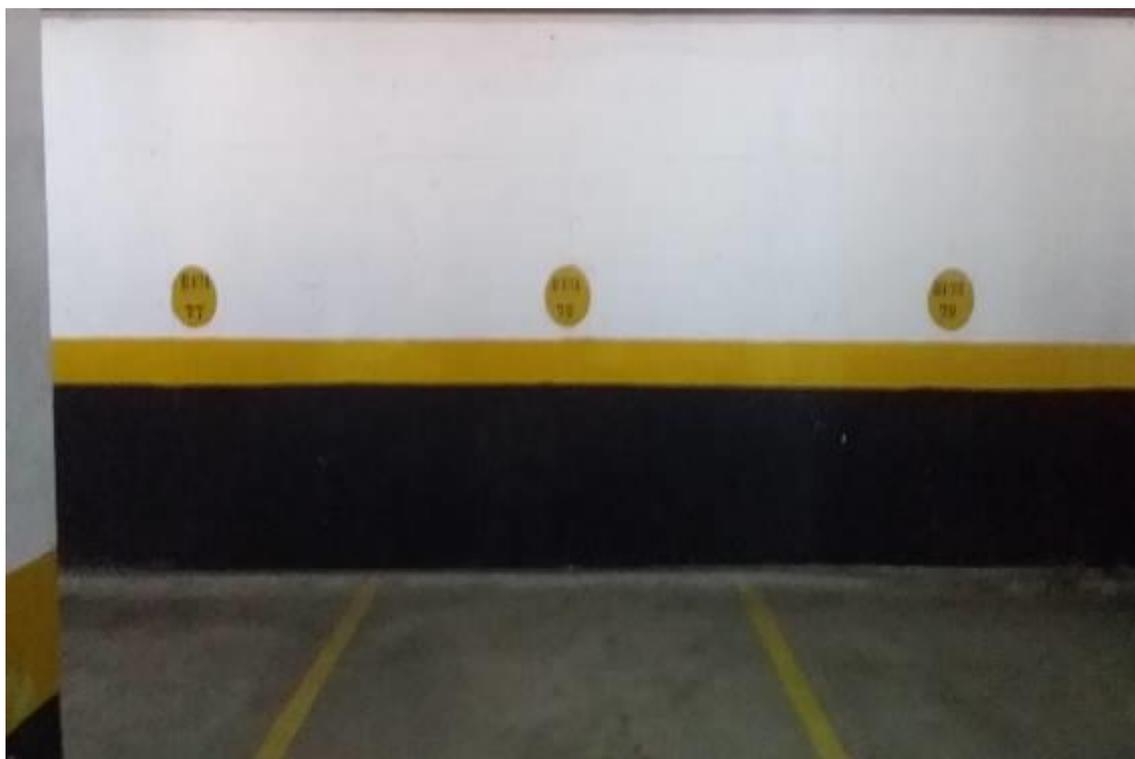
Vista da vaga de garagem de nº 78.
